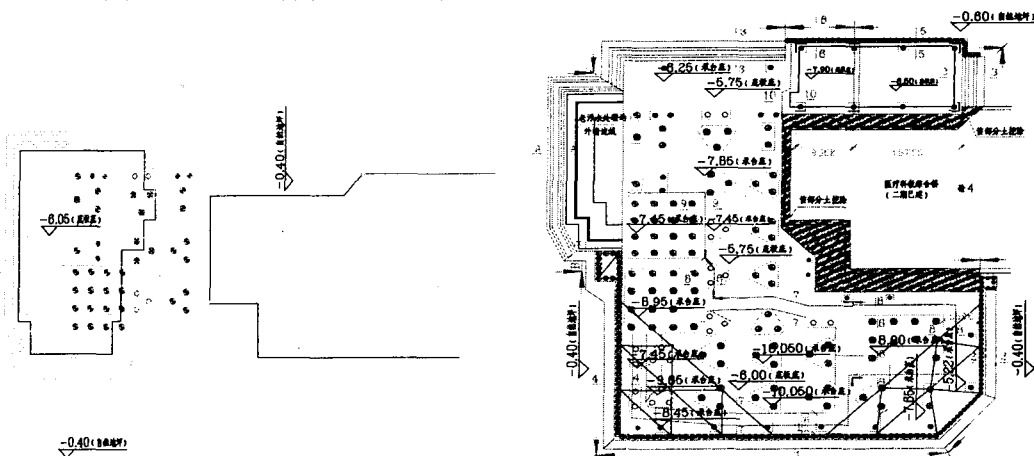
老污水处理站基坑处理平面图 图3 医技诊疗中心及新污水处理站基坑平面布置图
